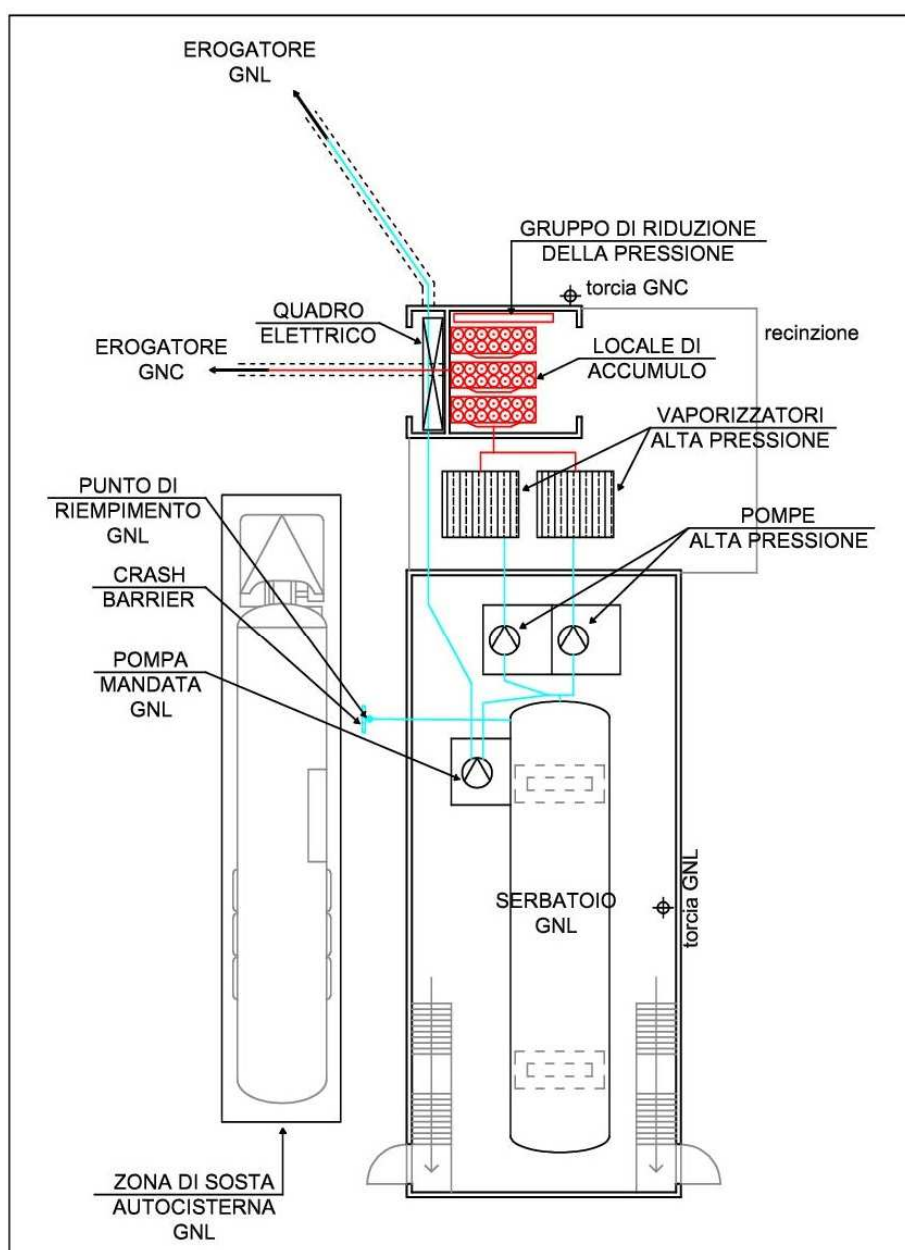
Planimetria impianto di distribuzione stradale per GNL e GNC
